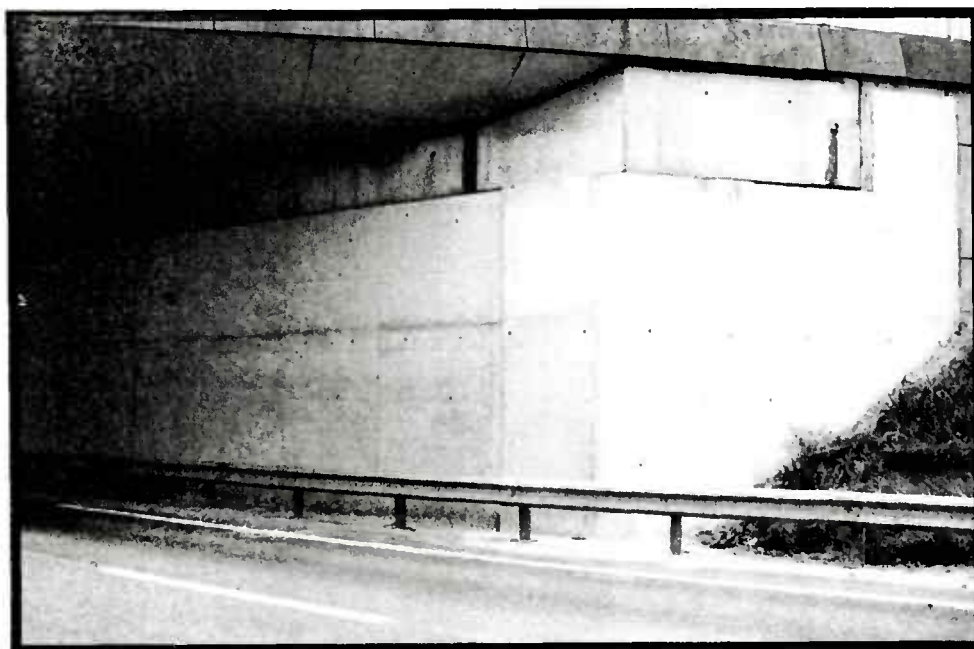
clouage d'écailles par deux clous de part et d'autre d'un obstacle
